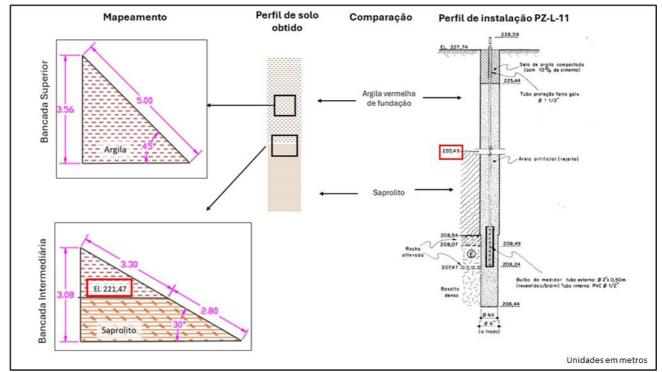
Perfil do instrumento PZ-L-11 instalado próximo a T15.
